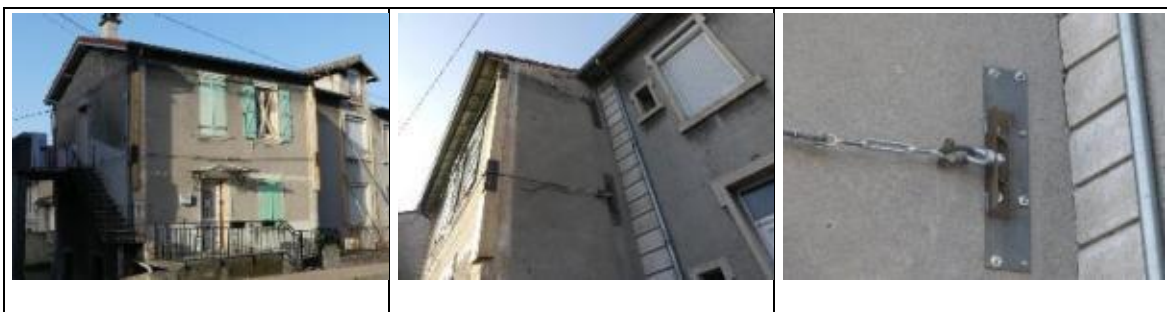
Mise en place d'une ceinture par câble bâtiment R+1.
